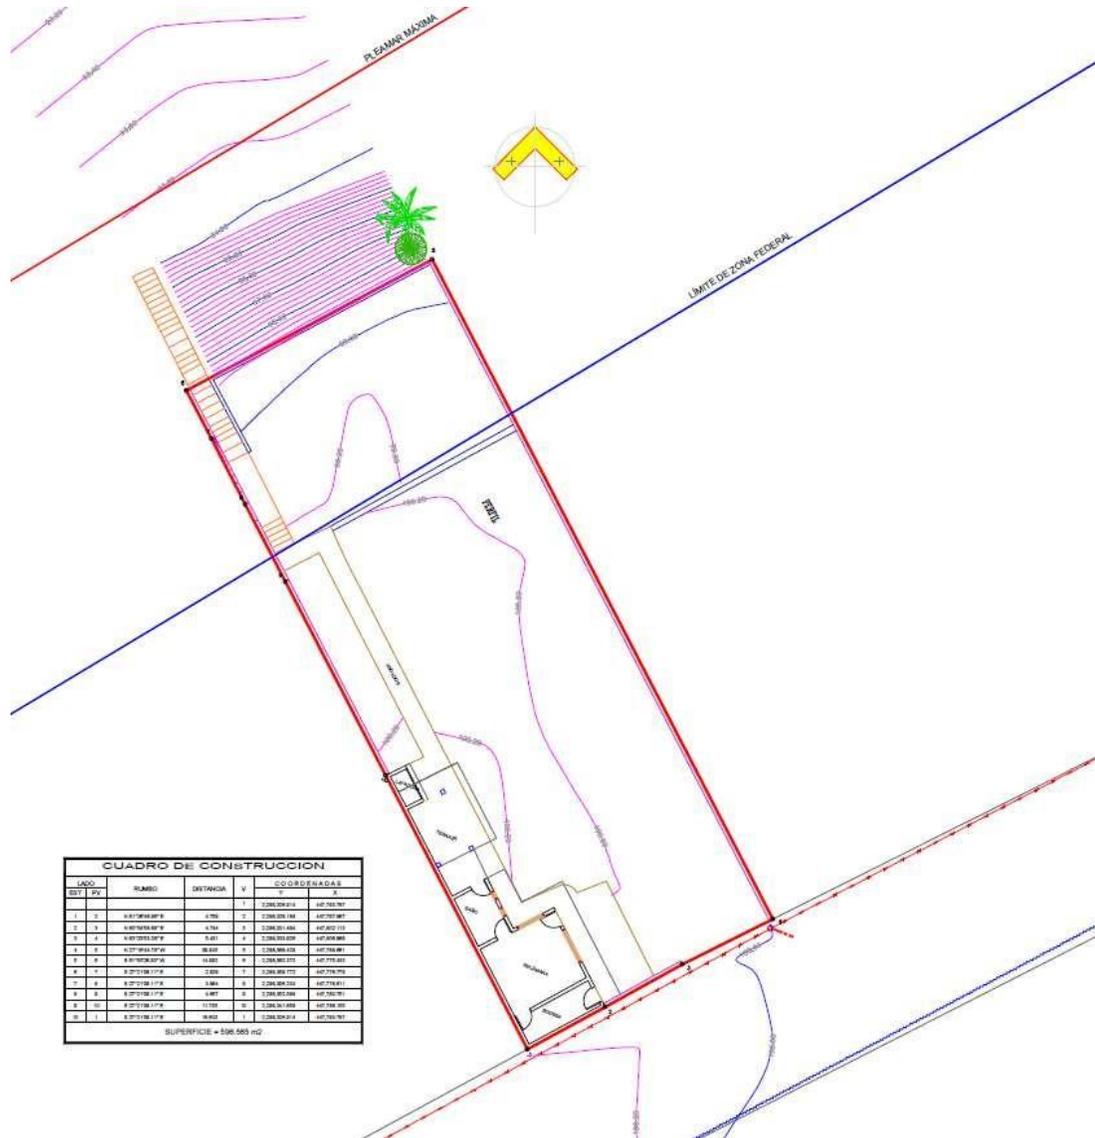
Levantamiento topográfico del Sitio del Proyecto (SP)
